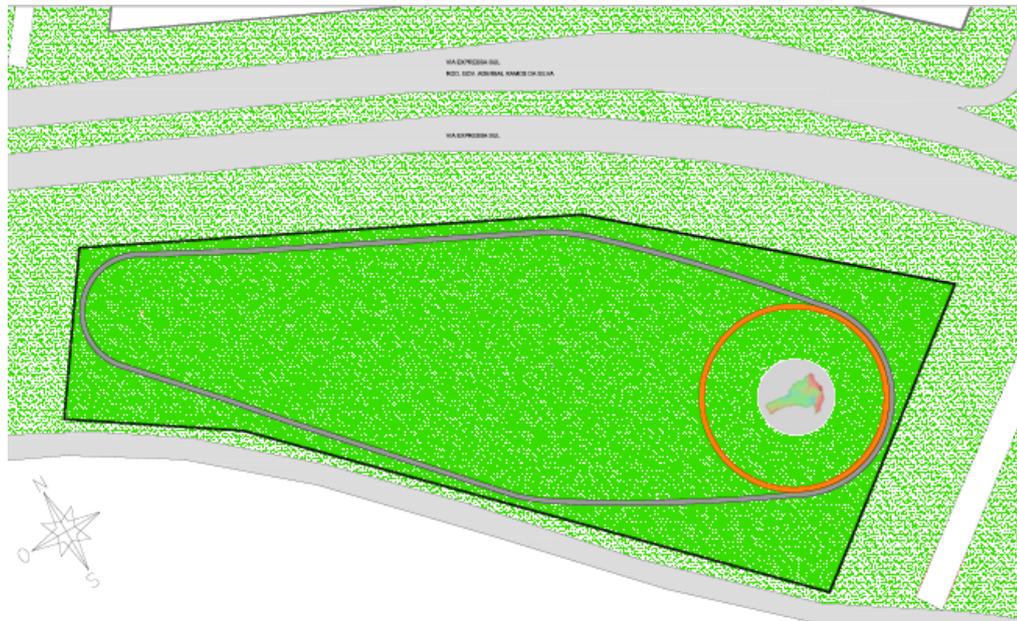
Planta baixa com a pista de caminhadas (já construída) e a maquete gigante do Estado de Santa Catarina (em processo de elaboração de licitação), implantados no lote sul do Parque Viva a Ciência.
